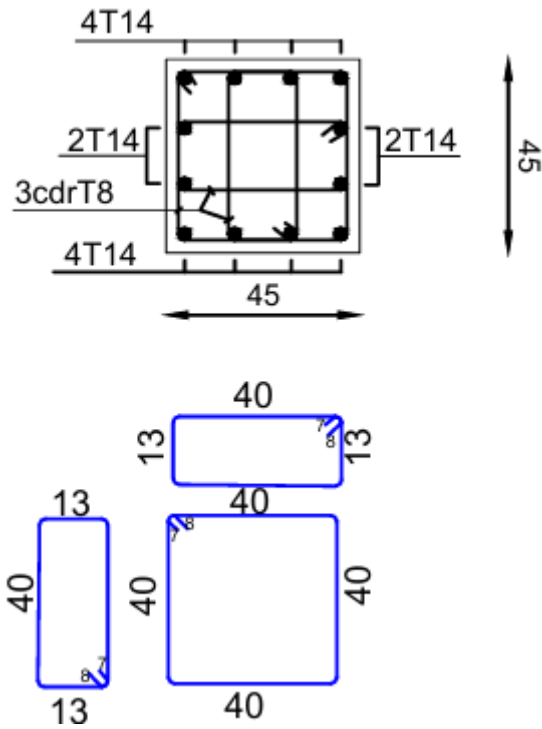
Schéma de ferrailage de poteau (45*45).
